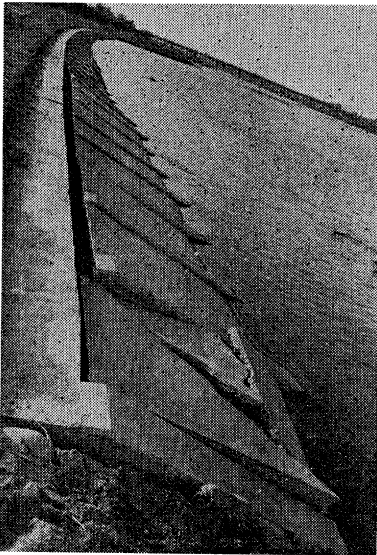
伊豆沼西側堤防のコンクリート護岸の被害
